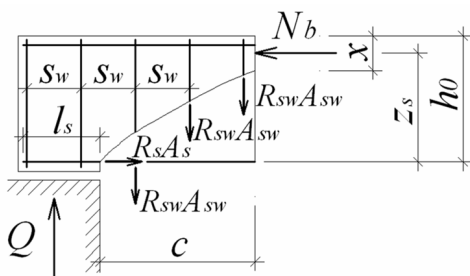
Схема усилий в наклонном сечении при расчете его по изгибающему моменту
